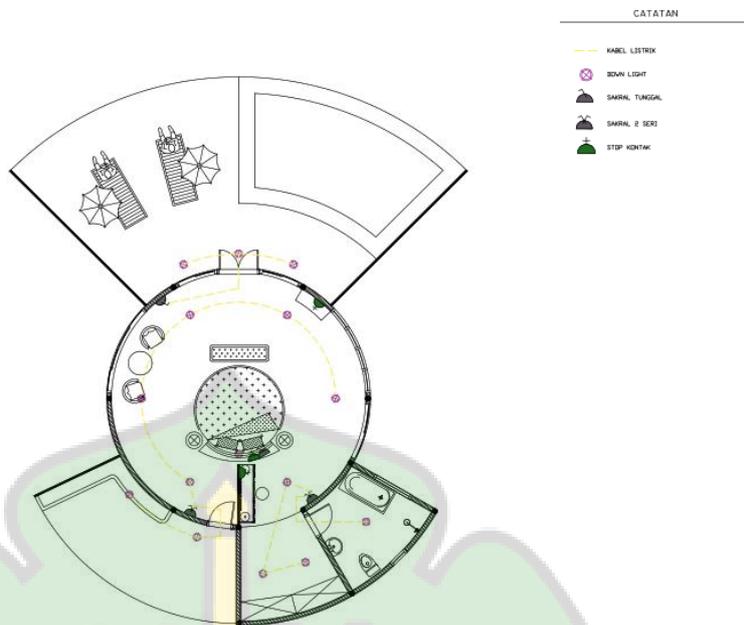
Rencana Instalasi Listrik dan Titik Lampu Lantai 1 Lobby dan Pengelola
